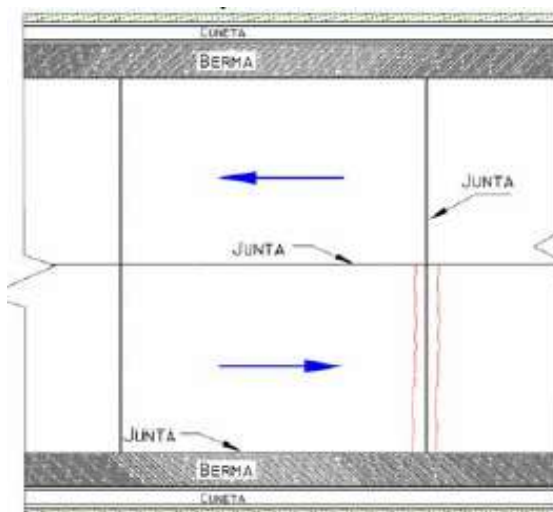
Vista en planta de grieta (GP) (INVIAS, 2006).
